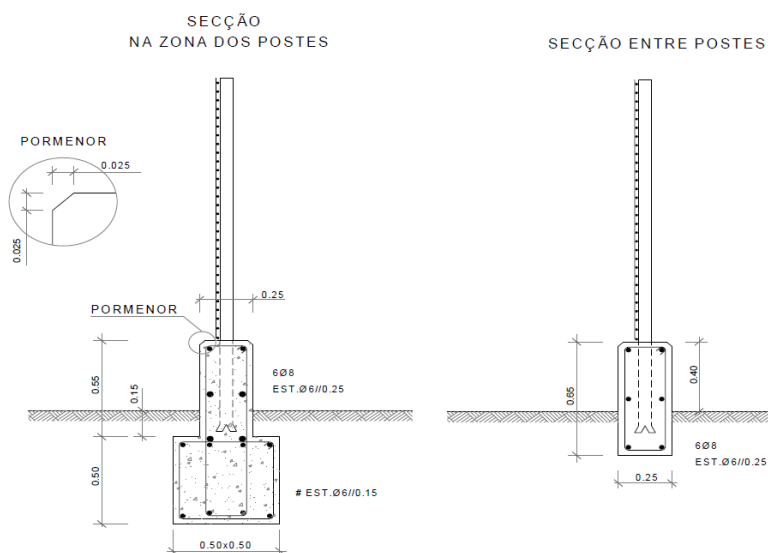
Geometria e pormenorização de armaduras do murete de apoio
